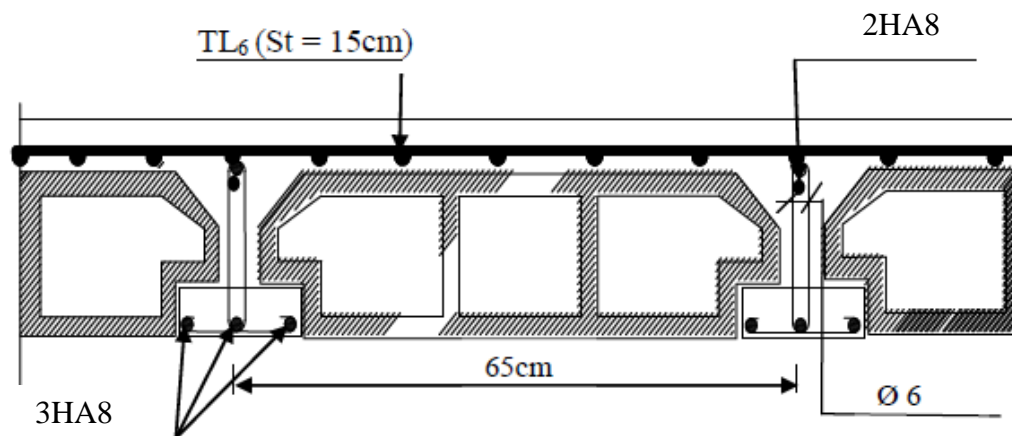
Plan de ferrailage du plancher en corps creux.
